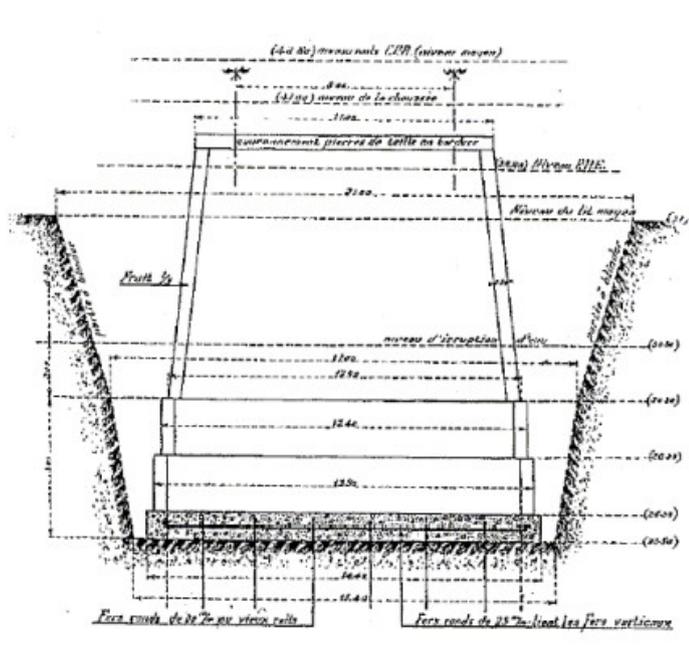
élévation d'une pile de rive de l'ouvrage amont (plan 1880) - extrait inspection périodique
